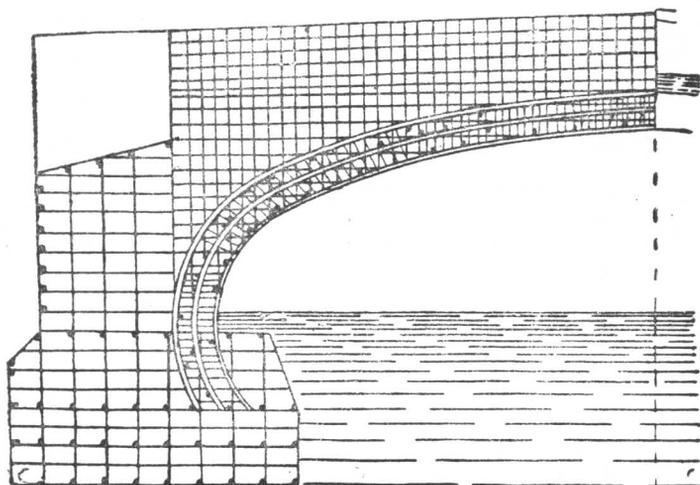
蒙耶氏体系的钢筋混凝土桥的型式
